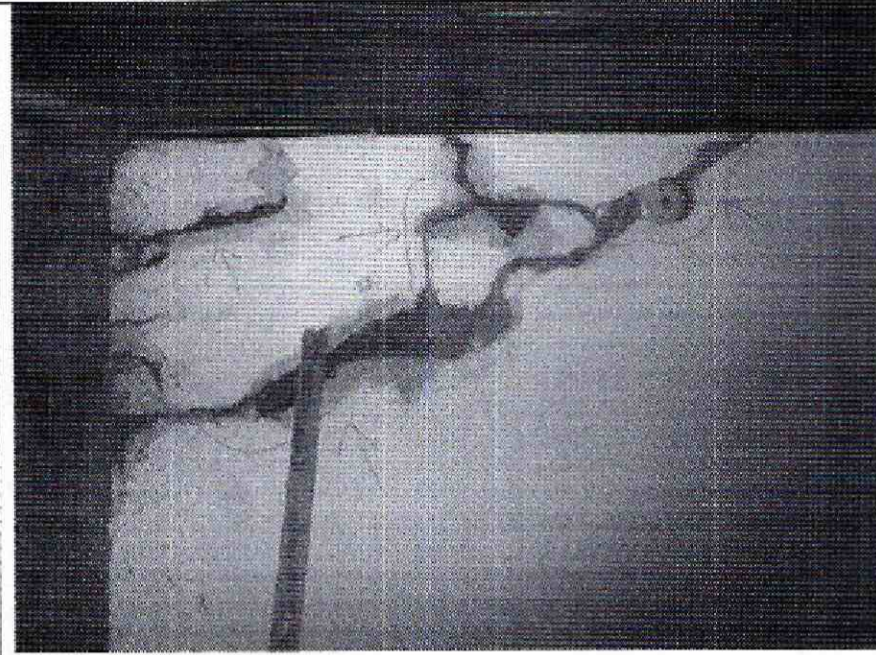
Grietas y fracturas en los muros internos de la edificación.
